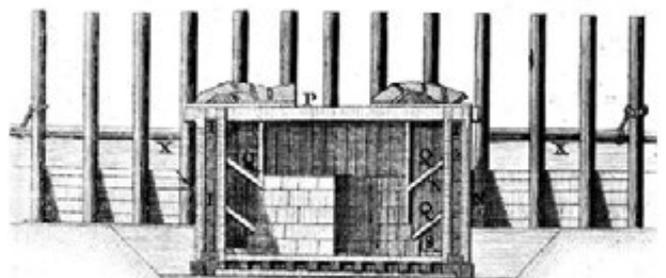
Caisson étanche échoué sur les fonds préalablement dragués (extrait d'Architecture Hydraulique tome II par Belidor - 1756)
